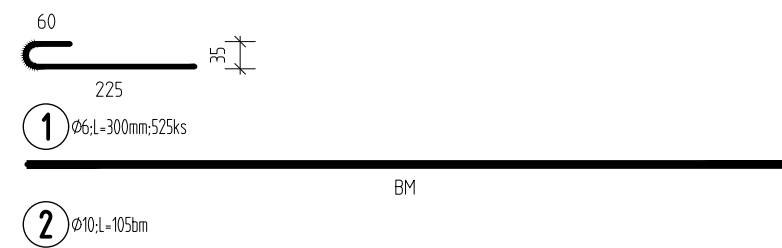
DETAIL NADBETONOVÁNÍ ATIKY M 1:10
